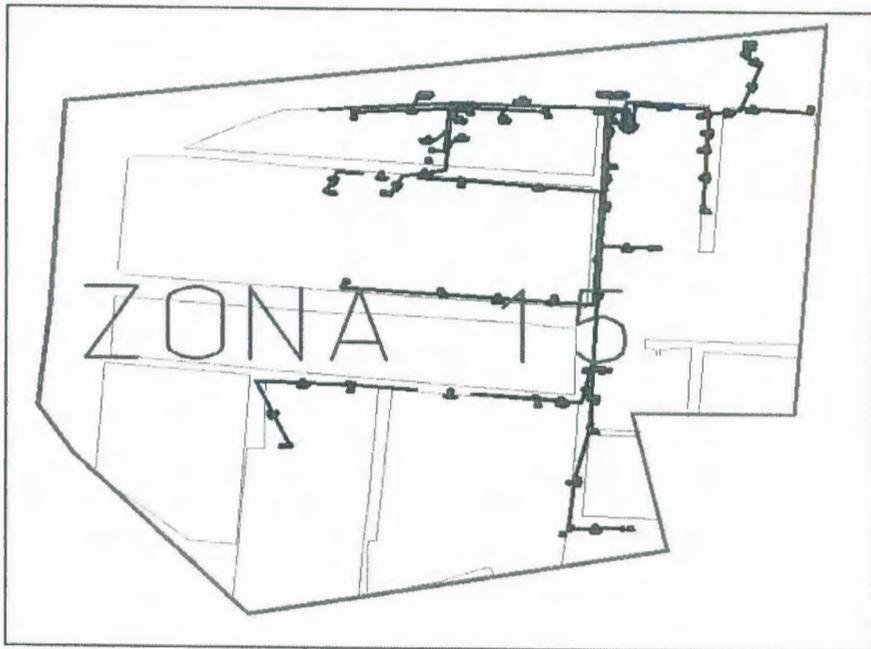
Planimetría zona 15 del sector de la vía a Daule
